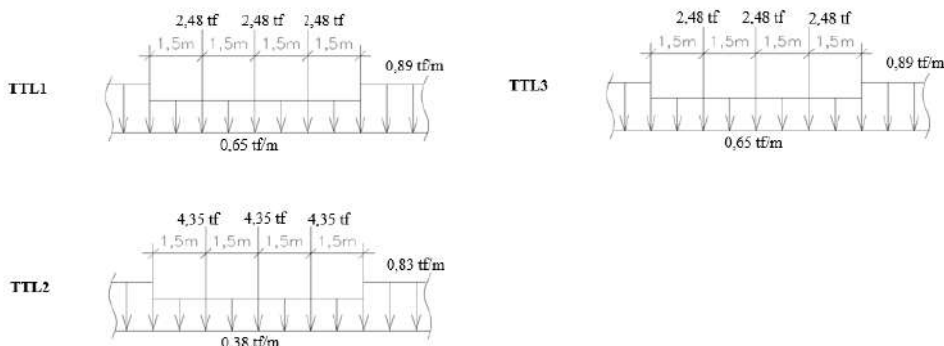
Trens-tipos longitudinais para as vigas longarinas em análise de fadiga dos materiais.
